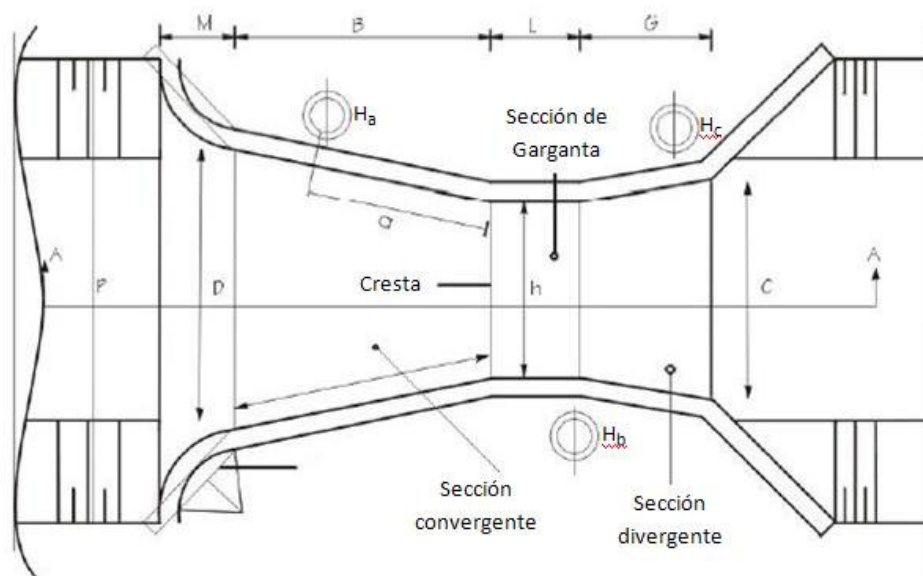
Dimensiones en planta para las Canaletas Parshall
